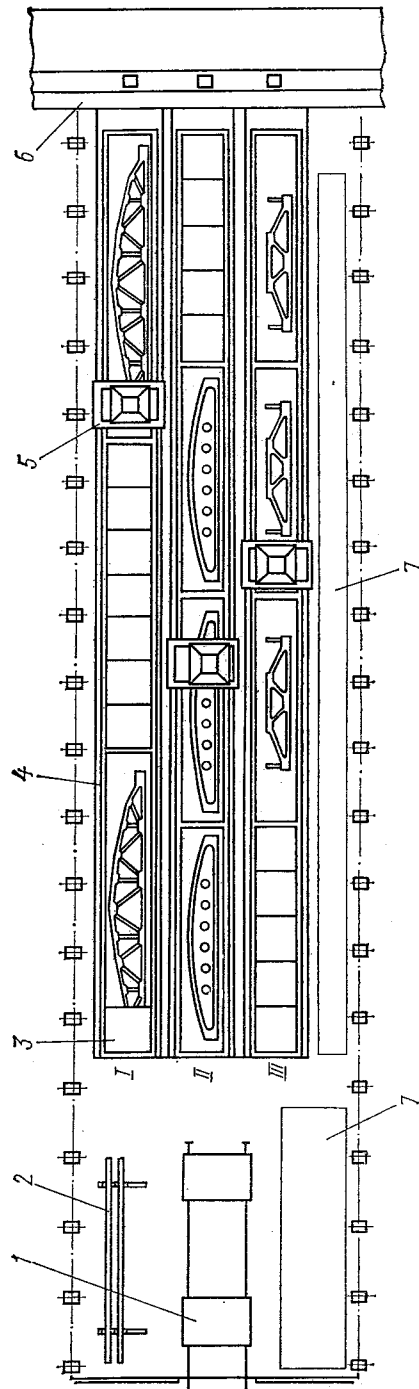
План формовочного цеха со стендовой схемой производства предварительно напряженных железобетонных конструкций в силовых формах.
